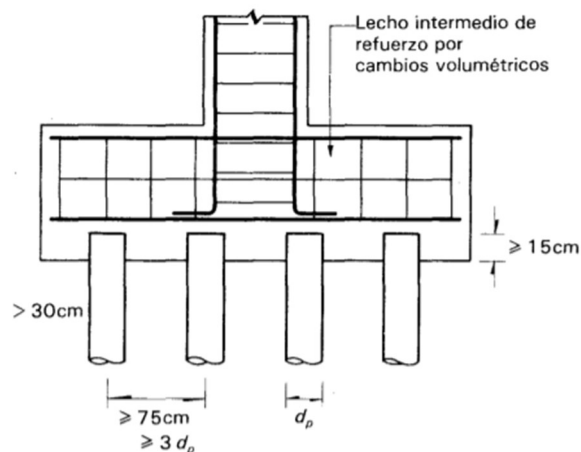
Ejemplo de la unión pilote-zapata y columna-zapata, donde se pueden observar los anclajes en los armados y como queda inmersa la pila en la zapata (Meli, 2018).
